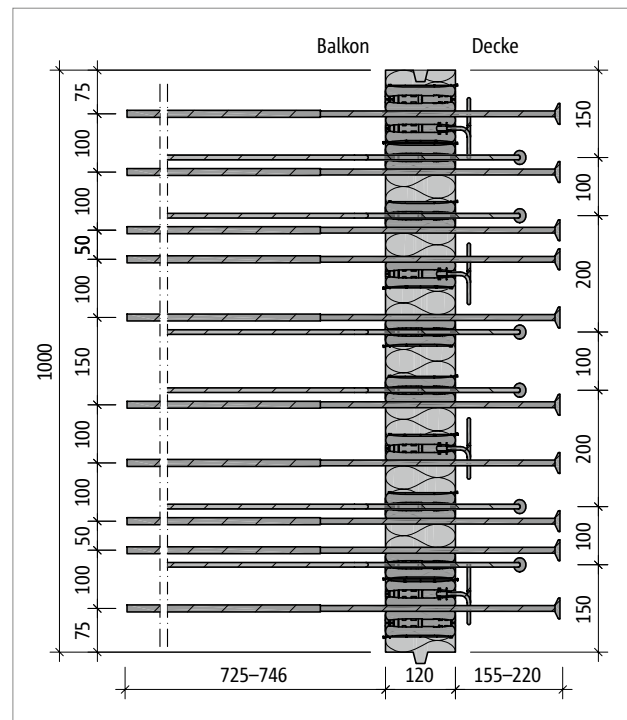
Schöck Isokorb® XT Typ KL-U-M4: Produktgrundriss
